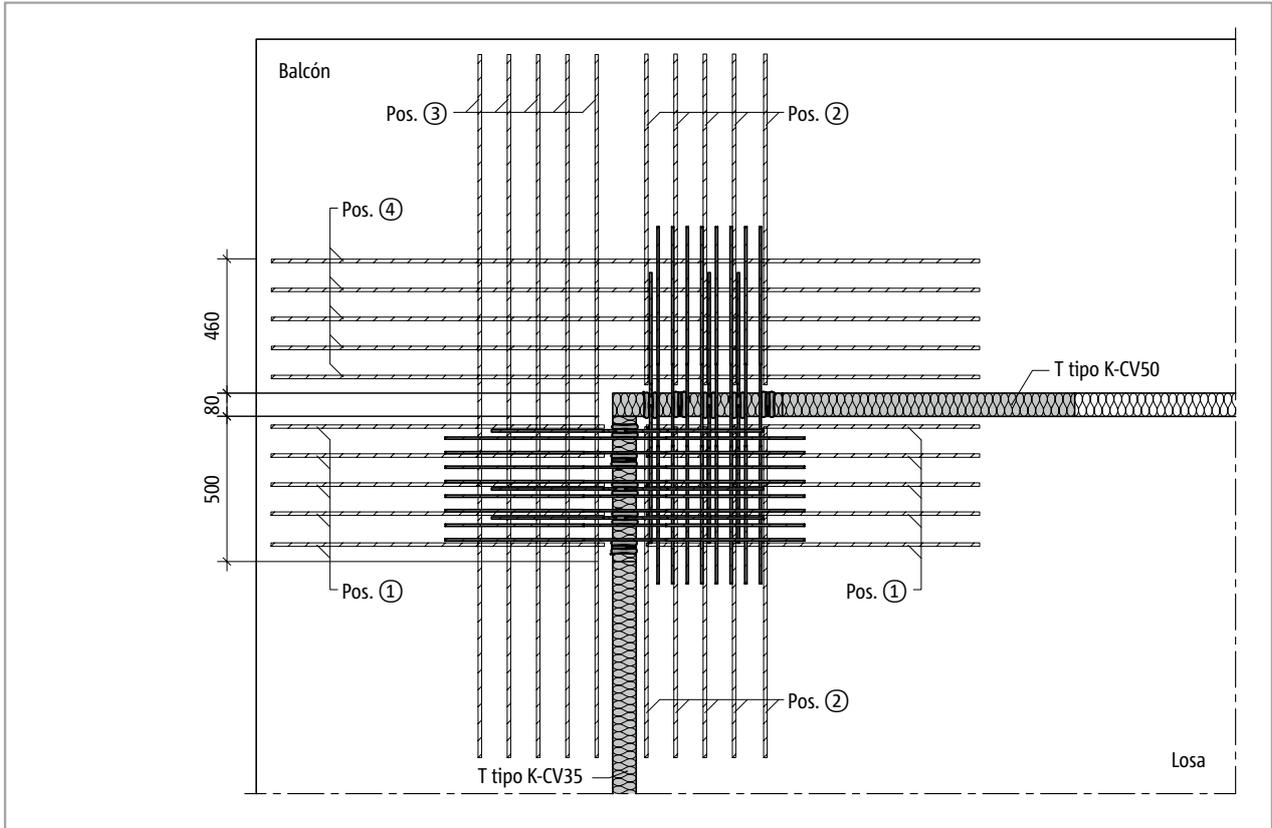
Schöck Isokorb® T tipo C-M1: Armadura in situ (posición superior)
